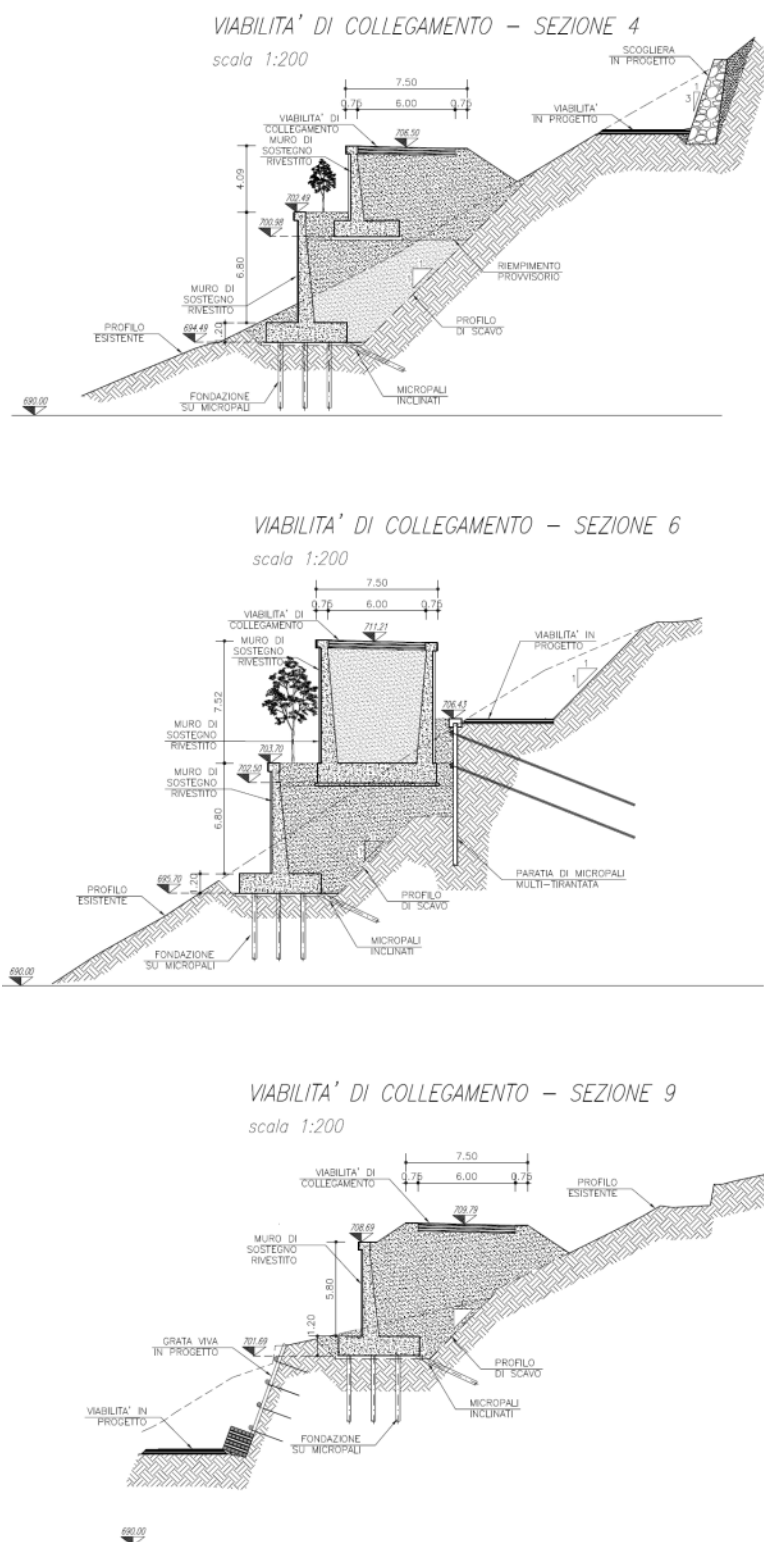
Sezioni su Viabilità di Accesso al Cantiere
